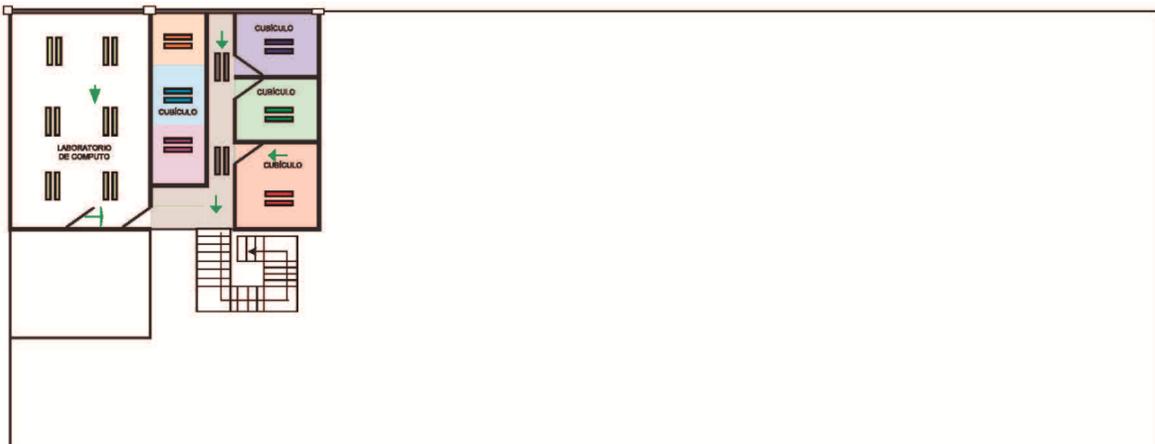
Edificio Taller Pesado “E”, Planta Alta
